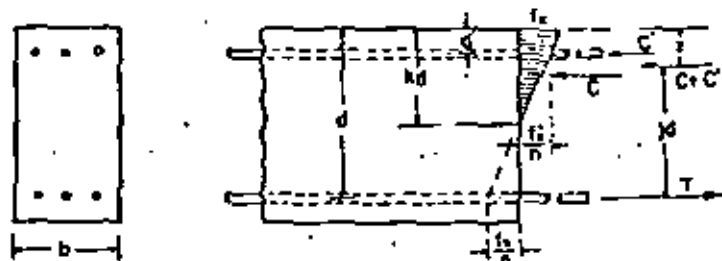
VIGAS CON REFUERZO PARA TENSION Y COMPRESION
